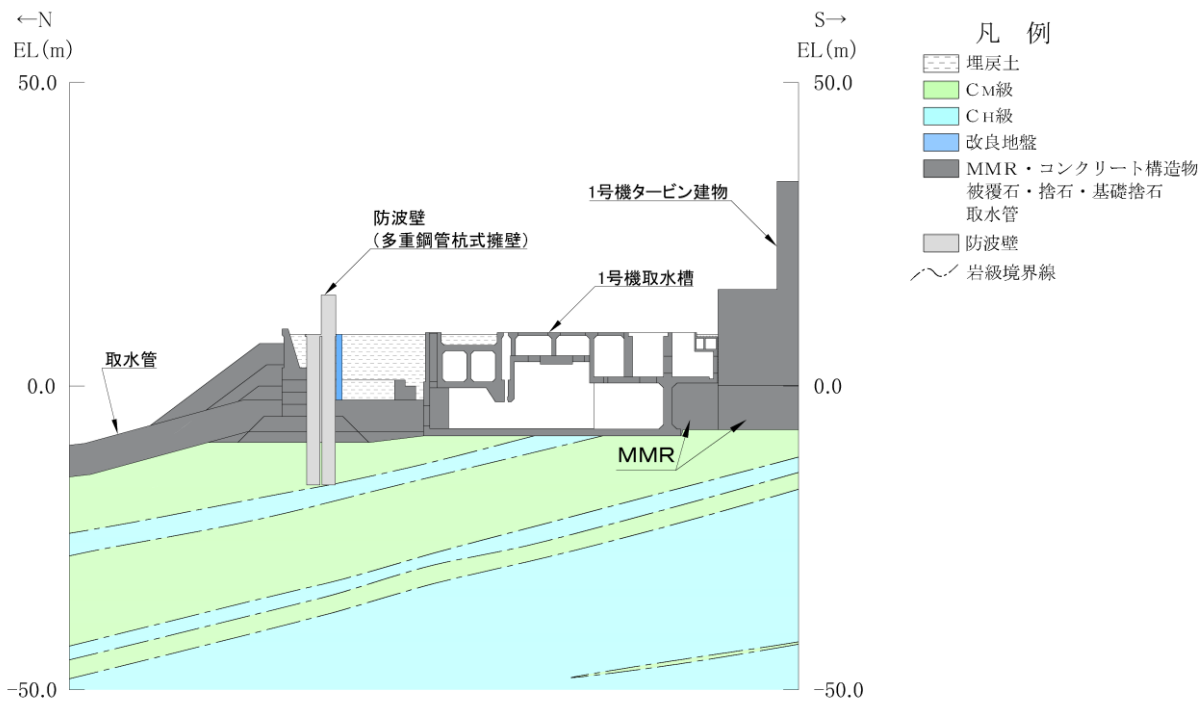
1号機取水槽 断面図(A-A断面)
